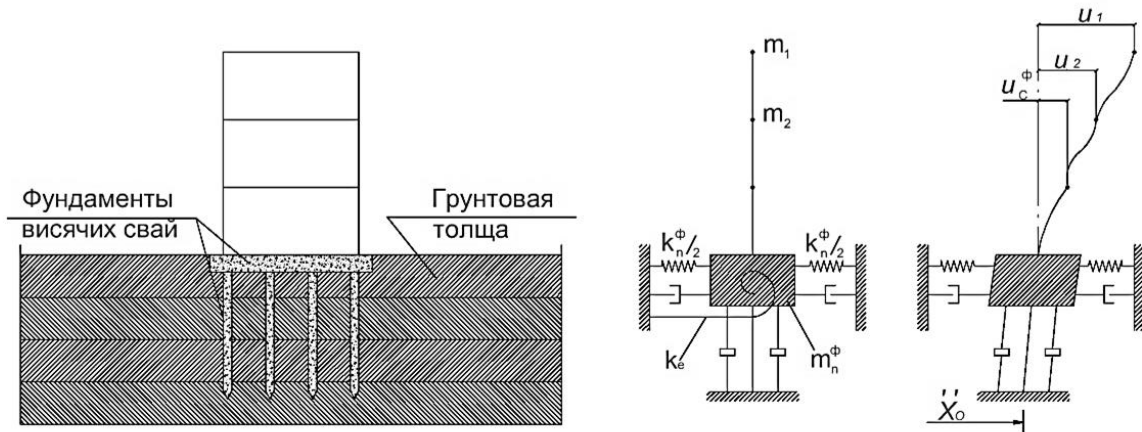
Система «здание – фундамент из висячих свай» и соответствующая расчетная схема
